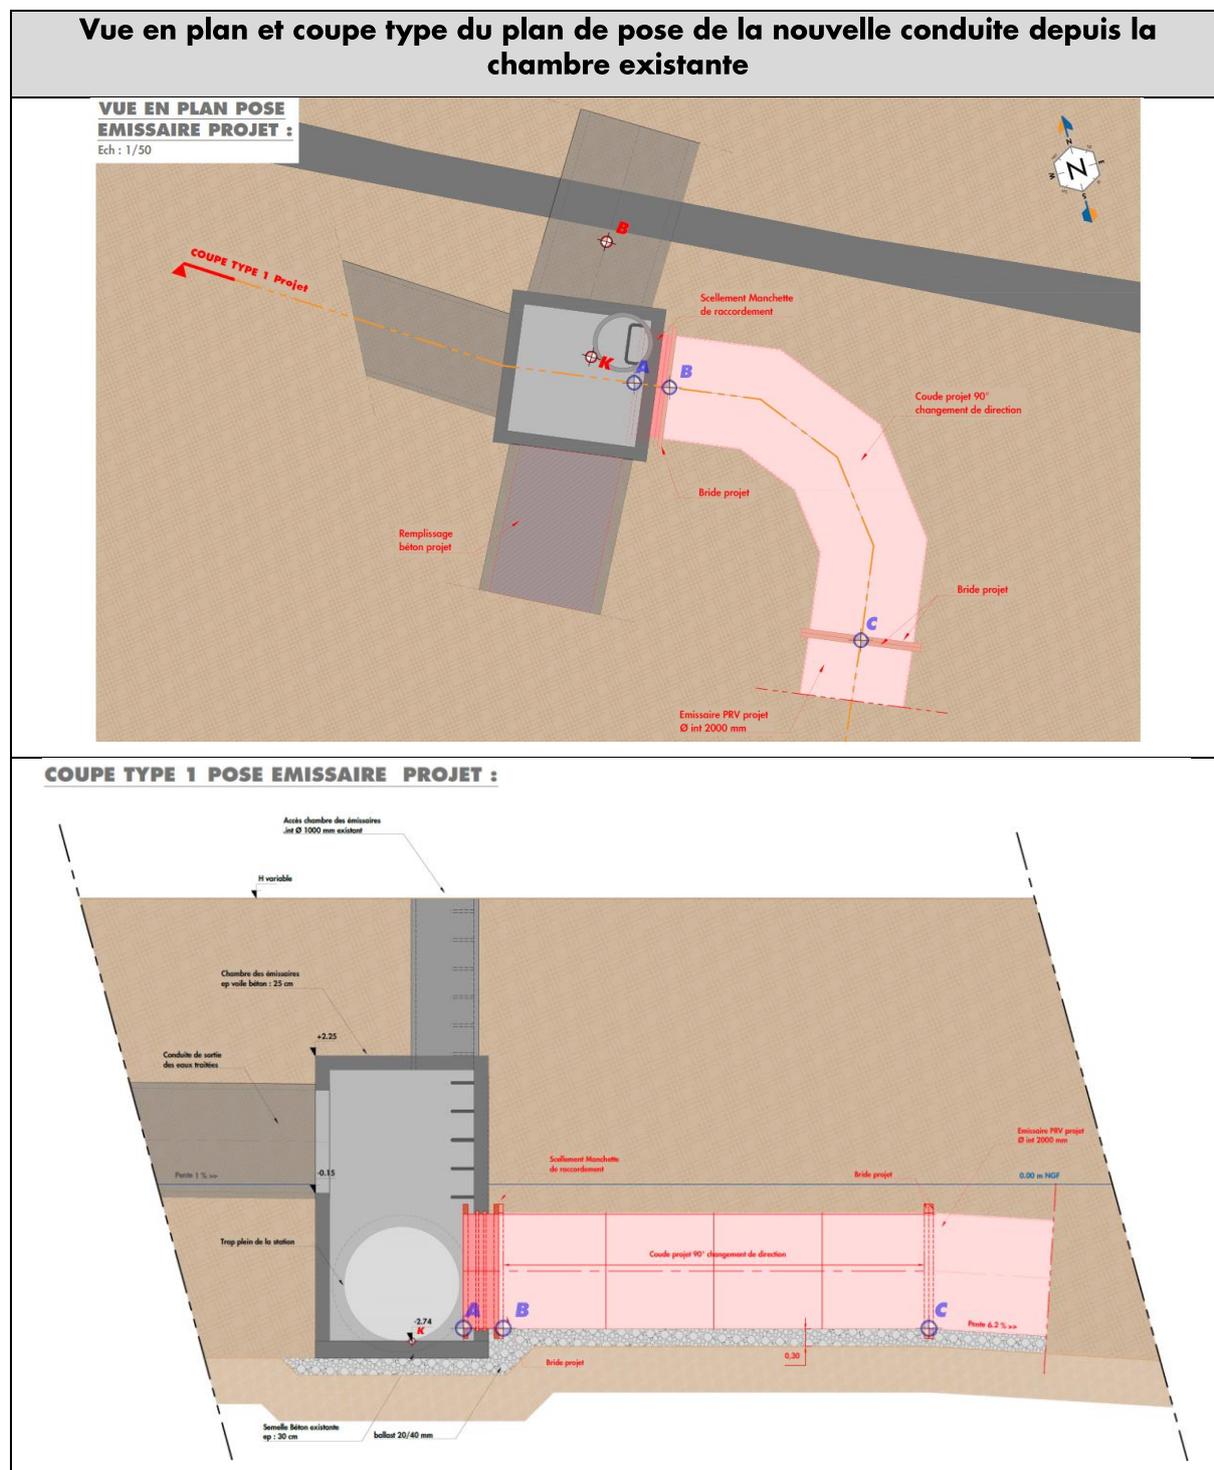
Vue en plan et coupe type du plan de pose de la nouvelle conduite depuis la chambre existante
